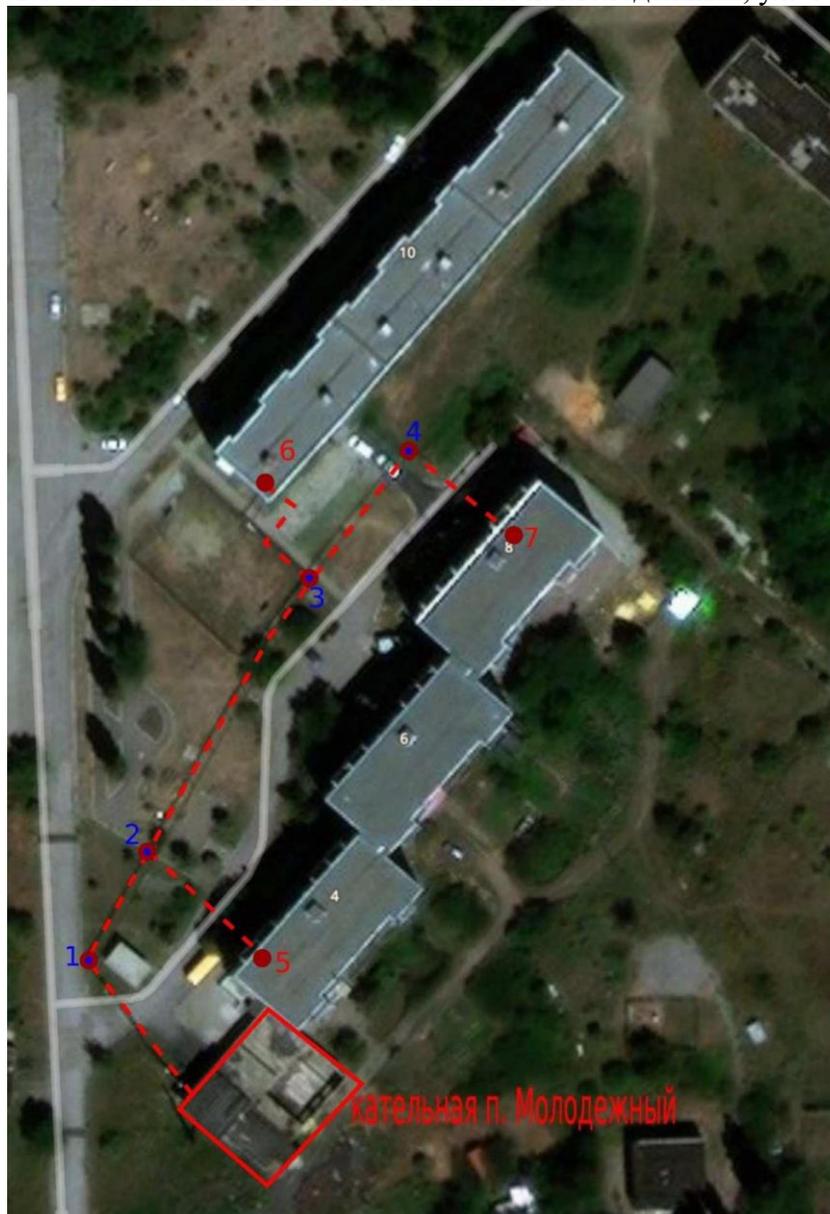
Схема тепловой сети котельной п. Молодежный, ул. Степная, №4-а
